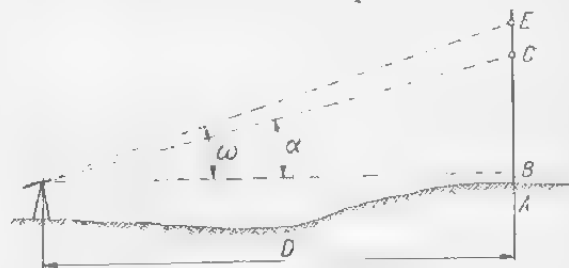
Măsurarea distanțelor dintre cele două conductoare în traversare.
